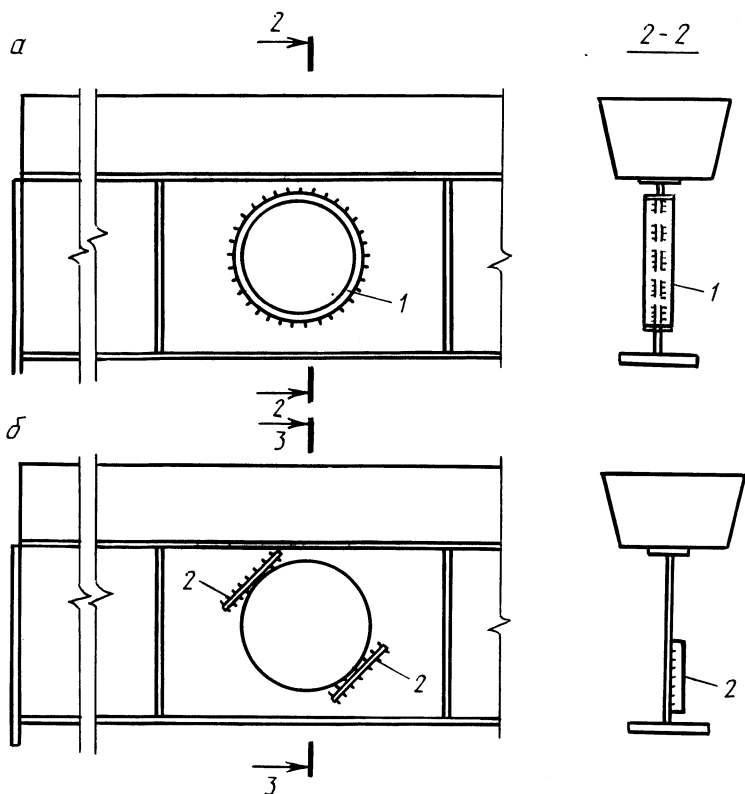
Конструкции подкрепления стенки сталежелезобетонной балки:
